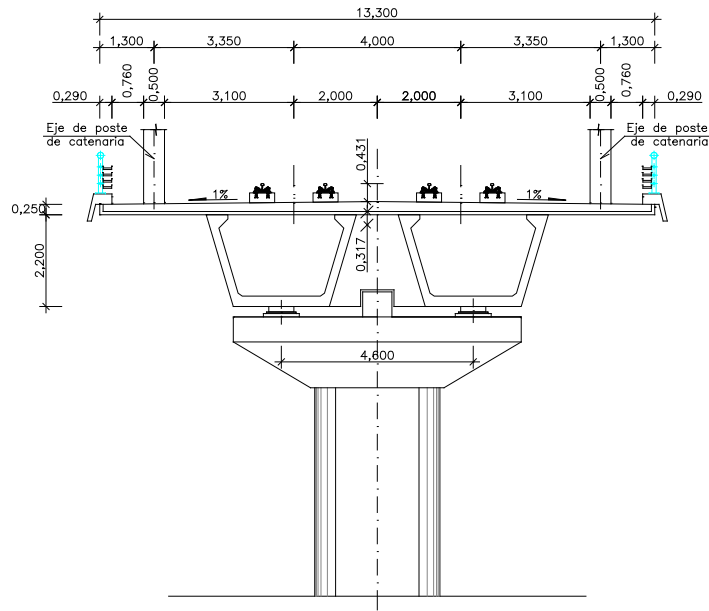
Sección tipo con dos traveses artesa prefabricadas
